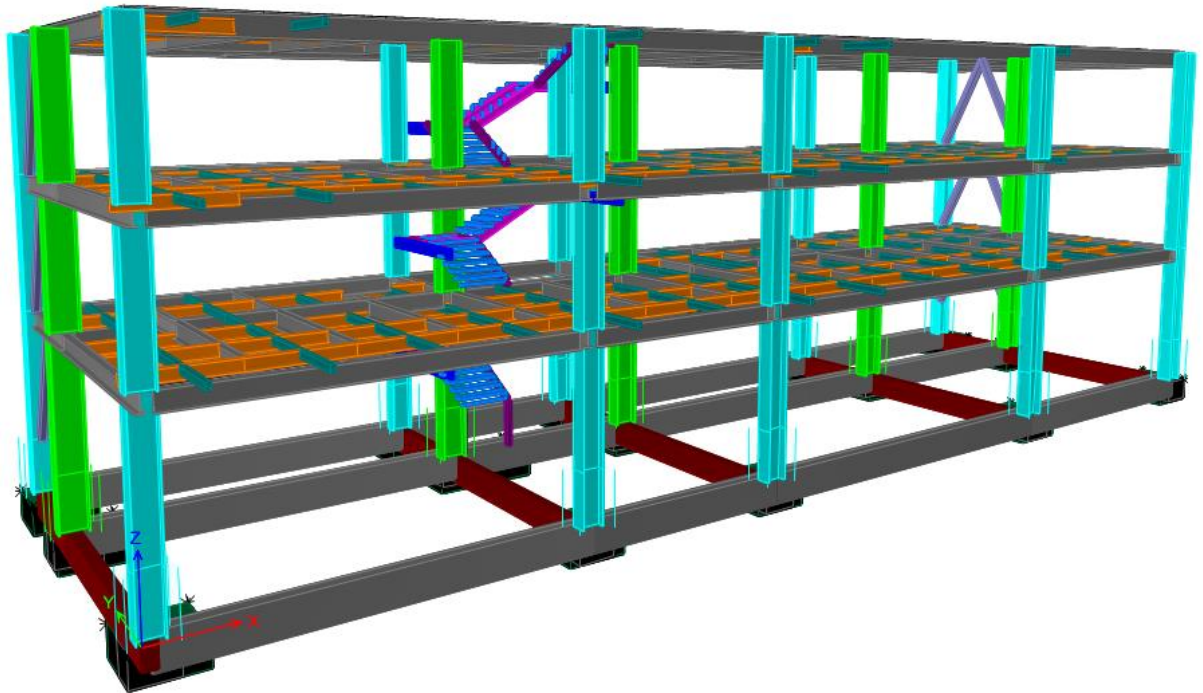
Análisis de la Sub Estructura del Sistema Estructural Mixto– Vista en 3D.
